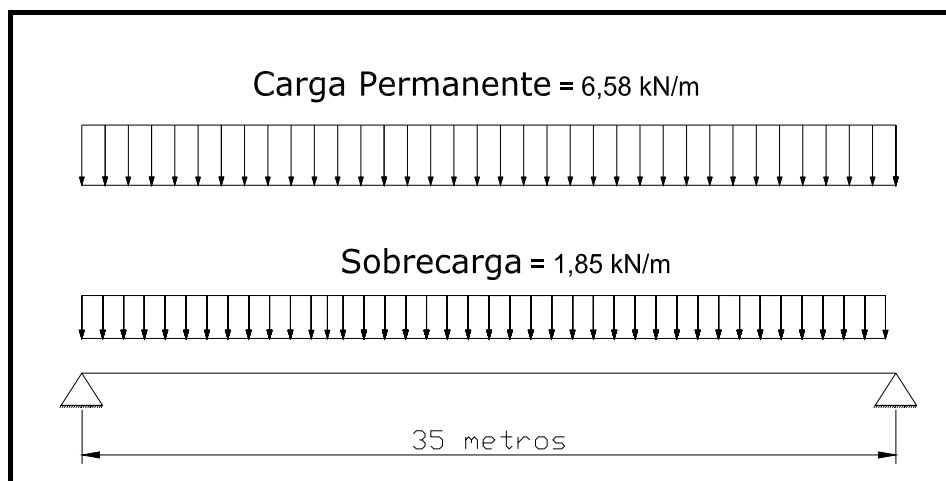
Esquema estrutural adoptado para a análise longitudinal da viga mista durante a fase construtiva.
